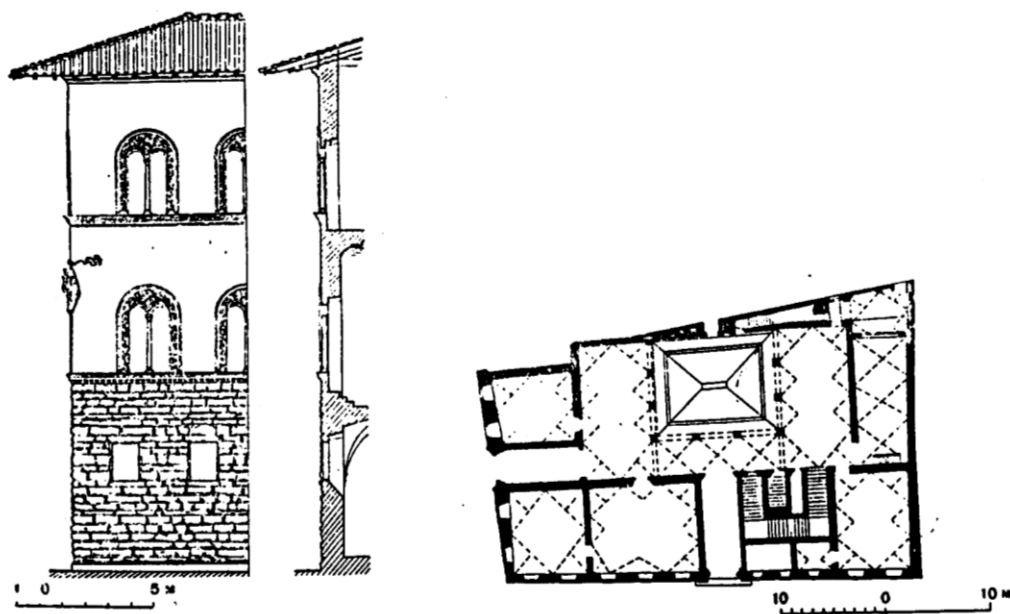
Флоренция. Палаццо Пацци. План Фрагмент фасада
